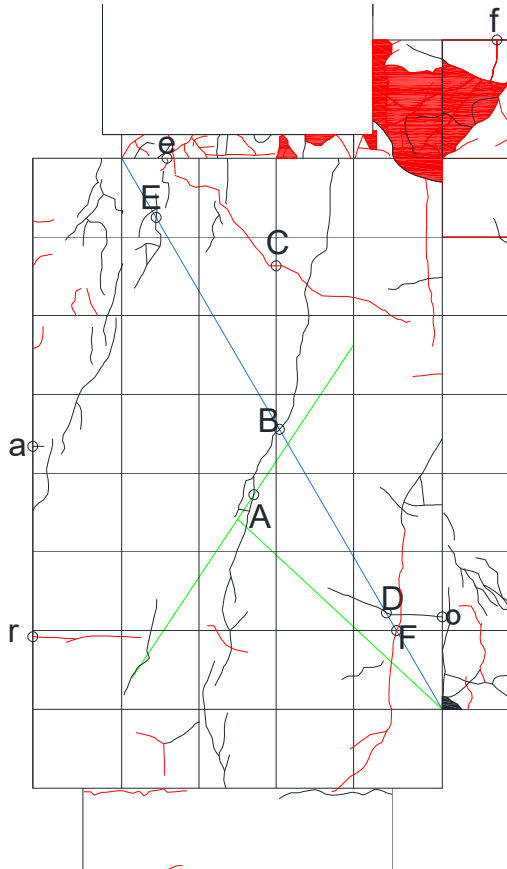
(左) パイルキャップひび割れ測定位置 (試験体 E-1 正載荷)
